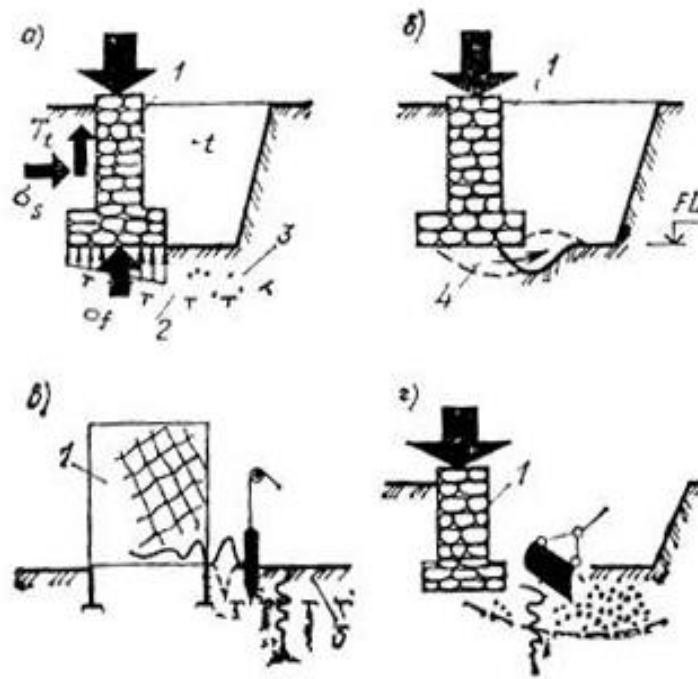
Порушення природного стану ґрунту при виконанні робіт по влаштуванню фундаментів: а - промороження ґрунту, б - перебір ґрунту, в, г - динамічний вплив механізмів; 1 - існуючий фундамент, 2 - межа сезонного промерзання ґрунту, 3 - мерзлий ґрунт, 4 - видавлювання ґрунту; σ_s і σ_f - нормальні напруження по боковій поверхні і по підшві фундаменту, T_t - сумарна дотична сила витріщення
